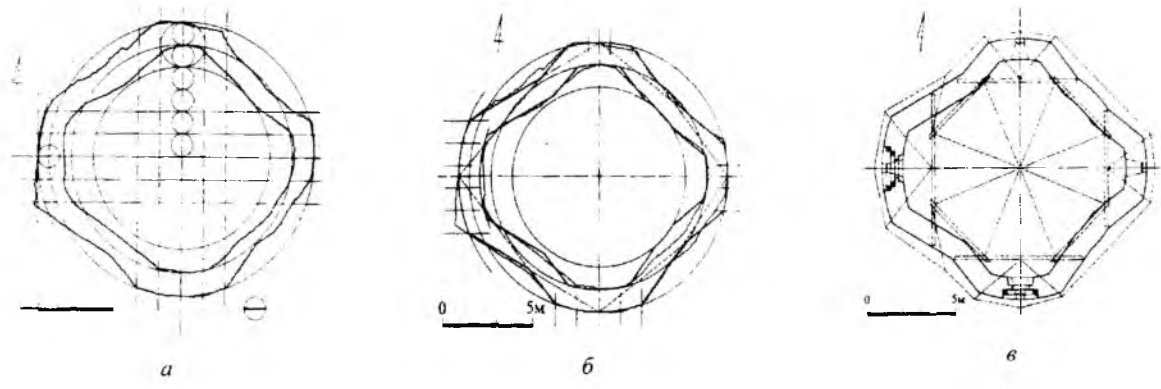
Особливості планувальної композиції квадрифолю “Полігон”: а – композиційний аналіз плану та визначення планувального модуля; б – реконструкція плану фундаментів; в – реконструкція плану споруди
